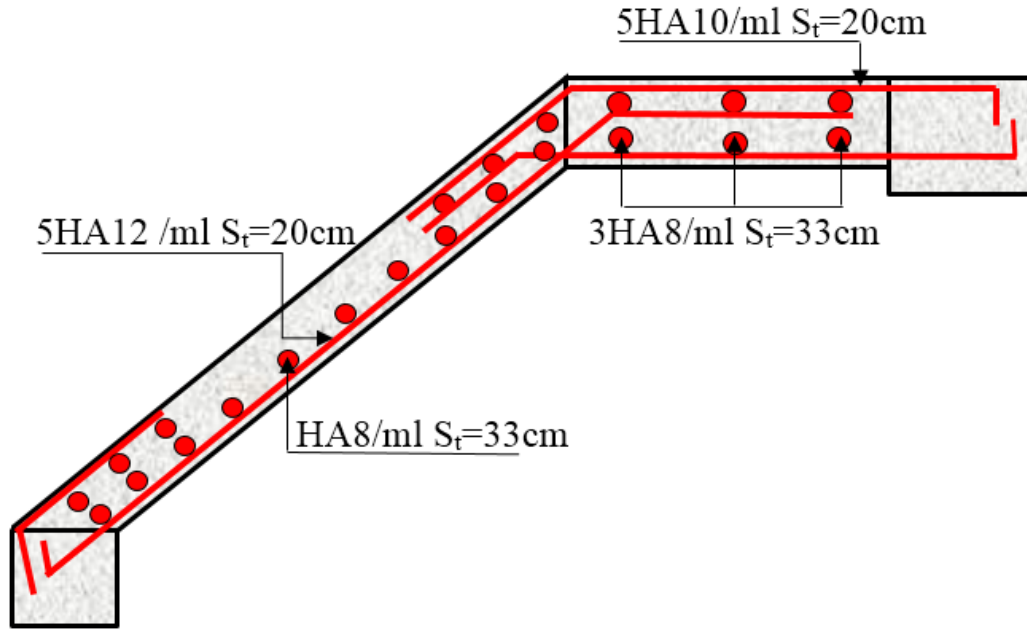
Schéma de ferrailage de l'escalier type 1 (partie AI)
